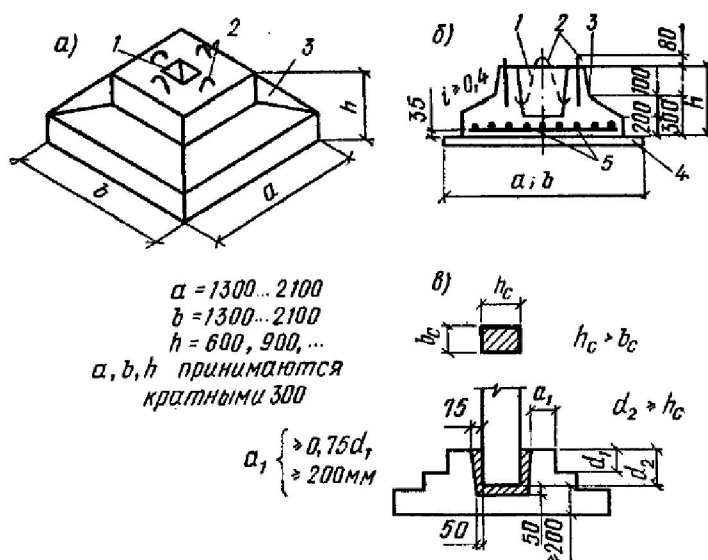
Сборные цельные железобетонные фундаменты колонн (а - общий вид; б - сечение; в - сопряжение сборной колонны с фундаментом; 1- гнездо колонны; 2- петли; 3- фундамент; 4- подготовка; 5- сварная сетка) [1]
